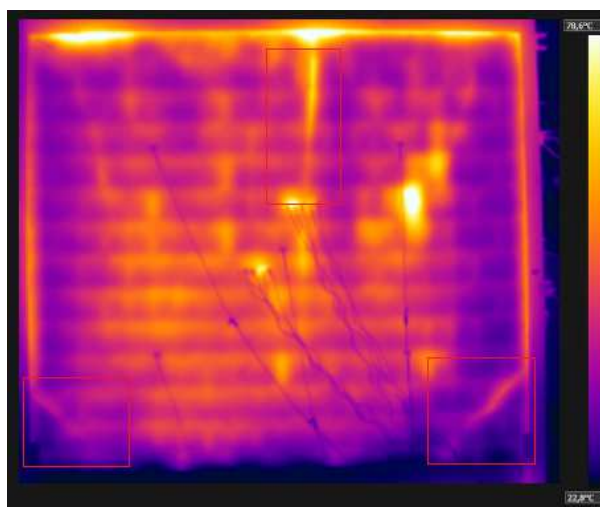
Aparecimento de fissura vertical e oblíquas na amostra
